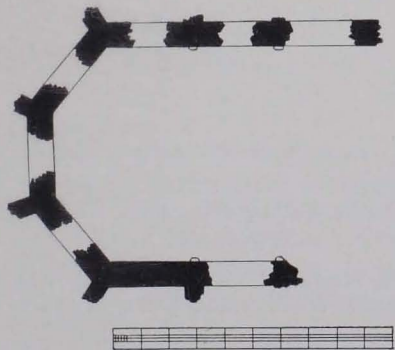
Raffingsberg, Grundriß des Chores der ehemaligen Wallfahrtskirche
